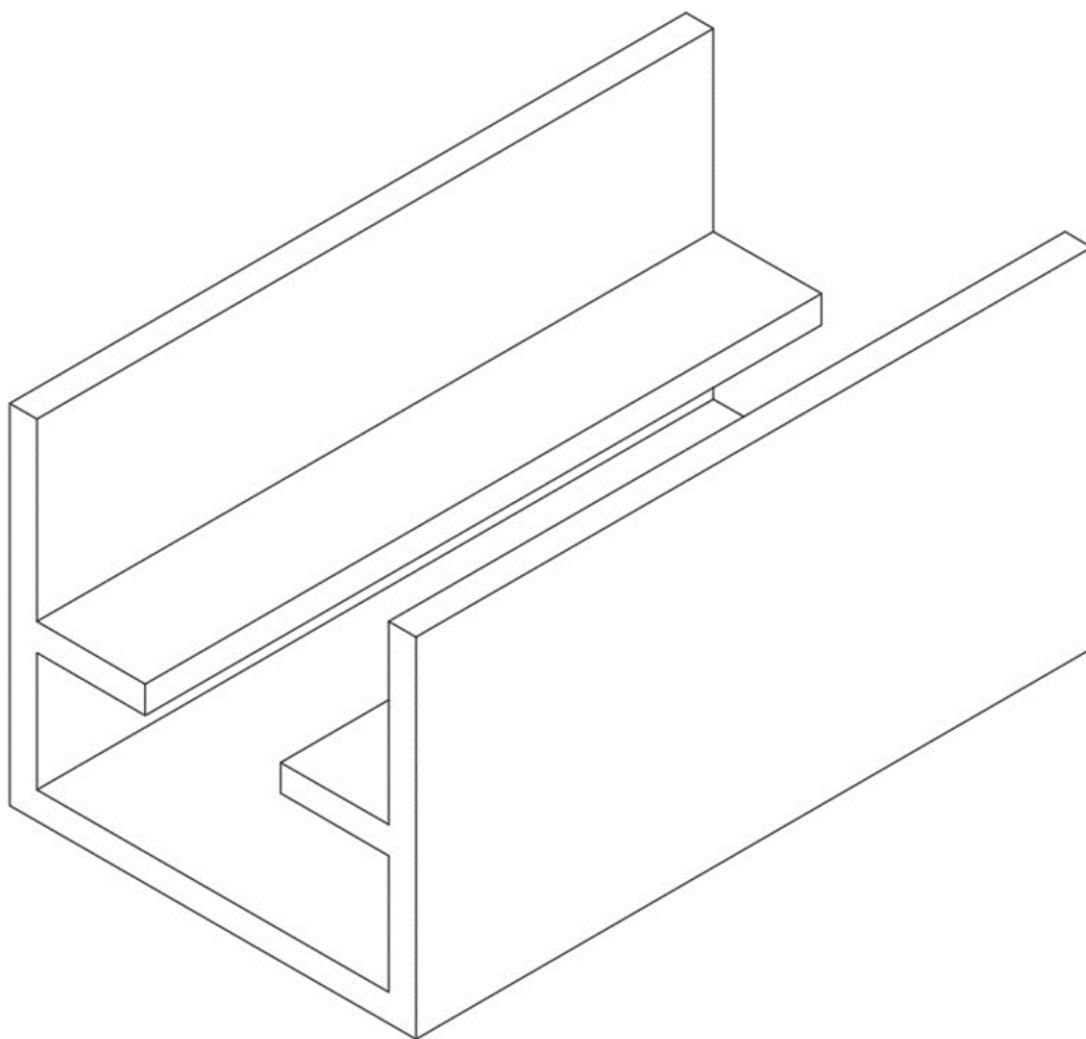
Détail du support de fixation pour le profilé SC-15 (charpente primaire).
